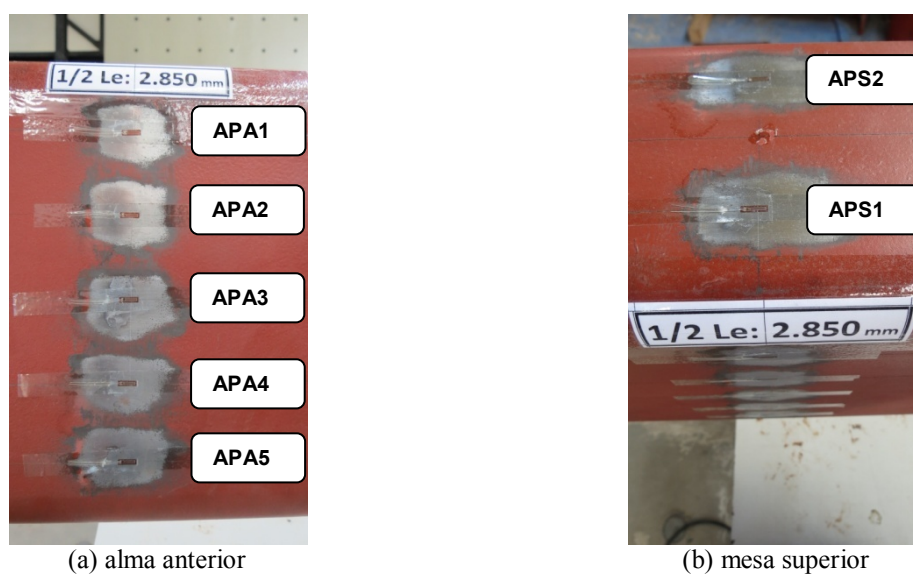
Ensaio de flexão: instrumentação do perfil de aço
